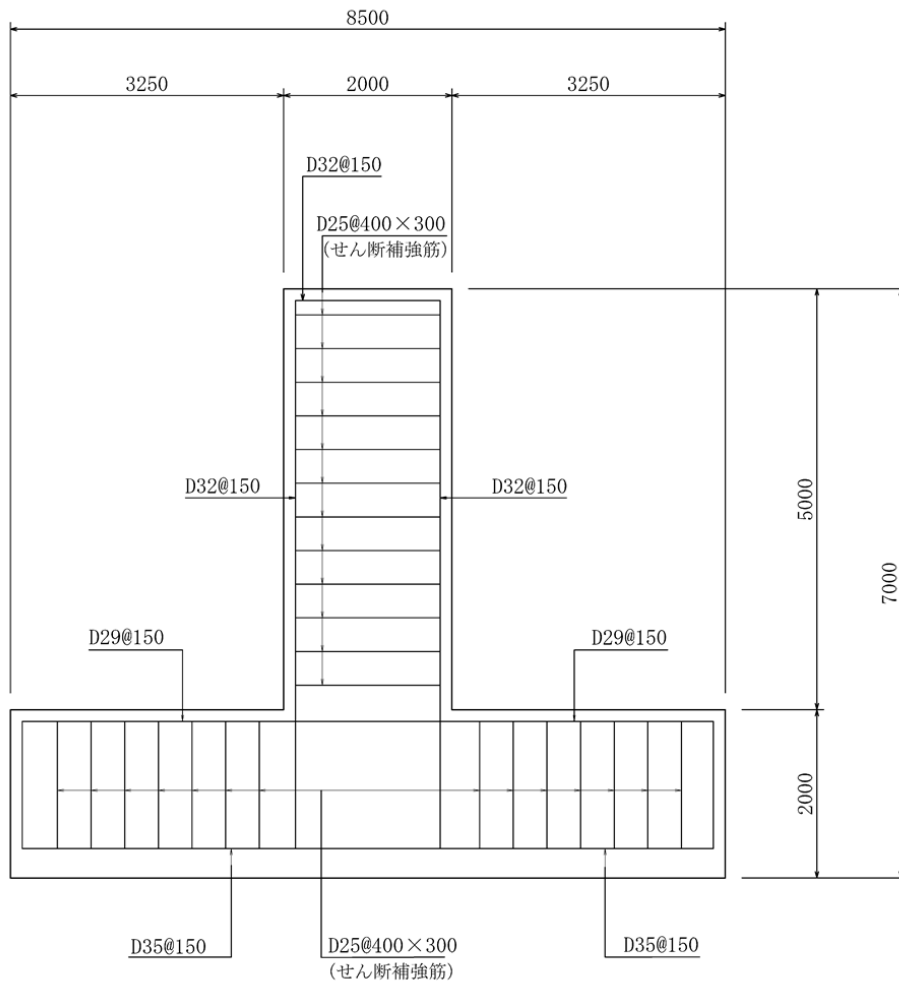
(3) 防波壁（逆 T 擁壁）の構造図（概略配筋図）
